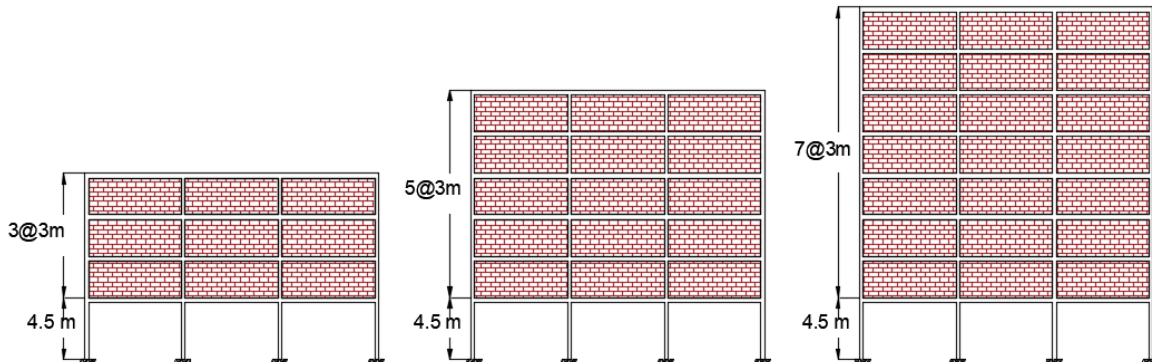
características geométricas en elevación de los edificios de concreto reforzado considerado muros diafragma de mampostería; a) muros exteriores, y b) muros interiores
